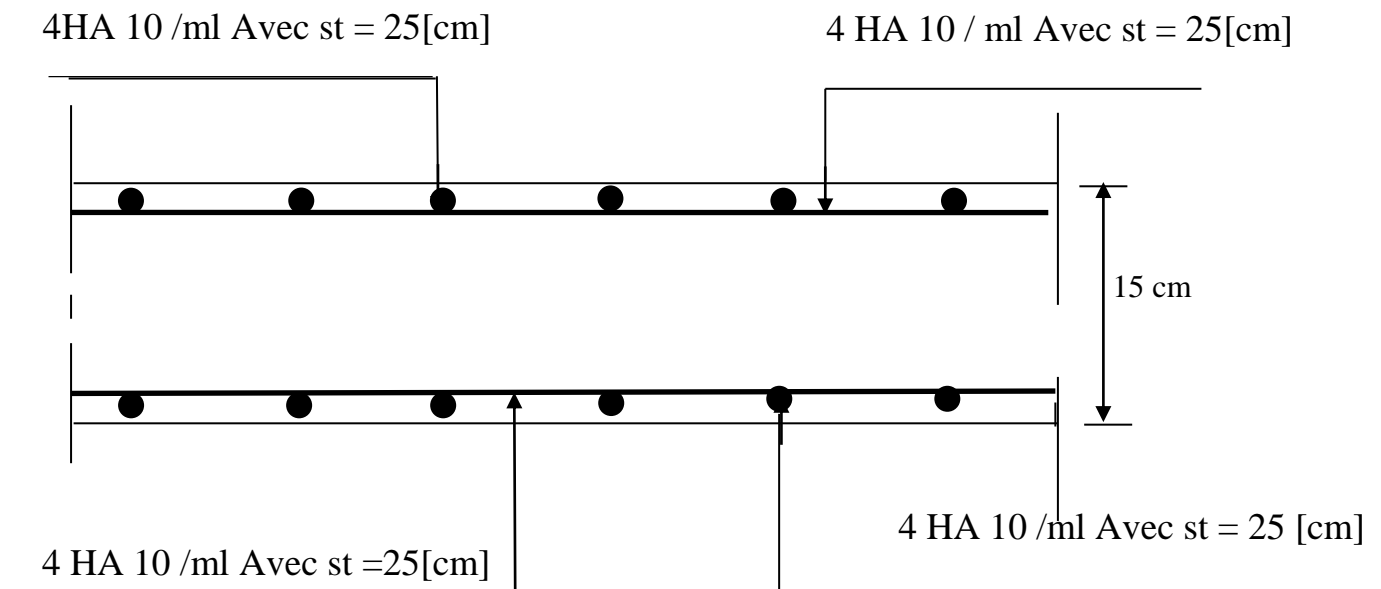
Ferraillage de la dalle dans le sens Y-Y
